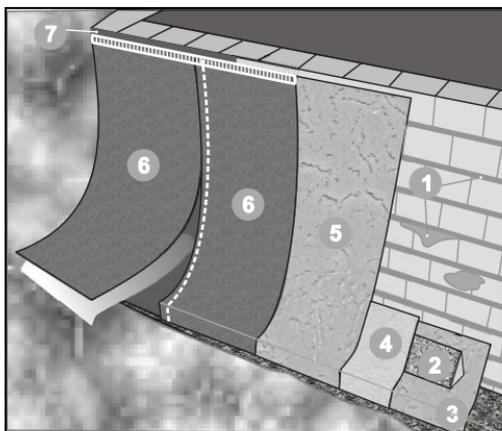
Гидроизоляция пленками SK 3000 S:
